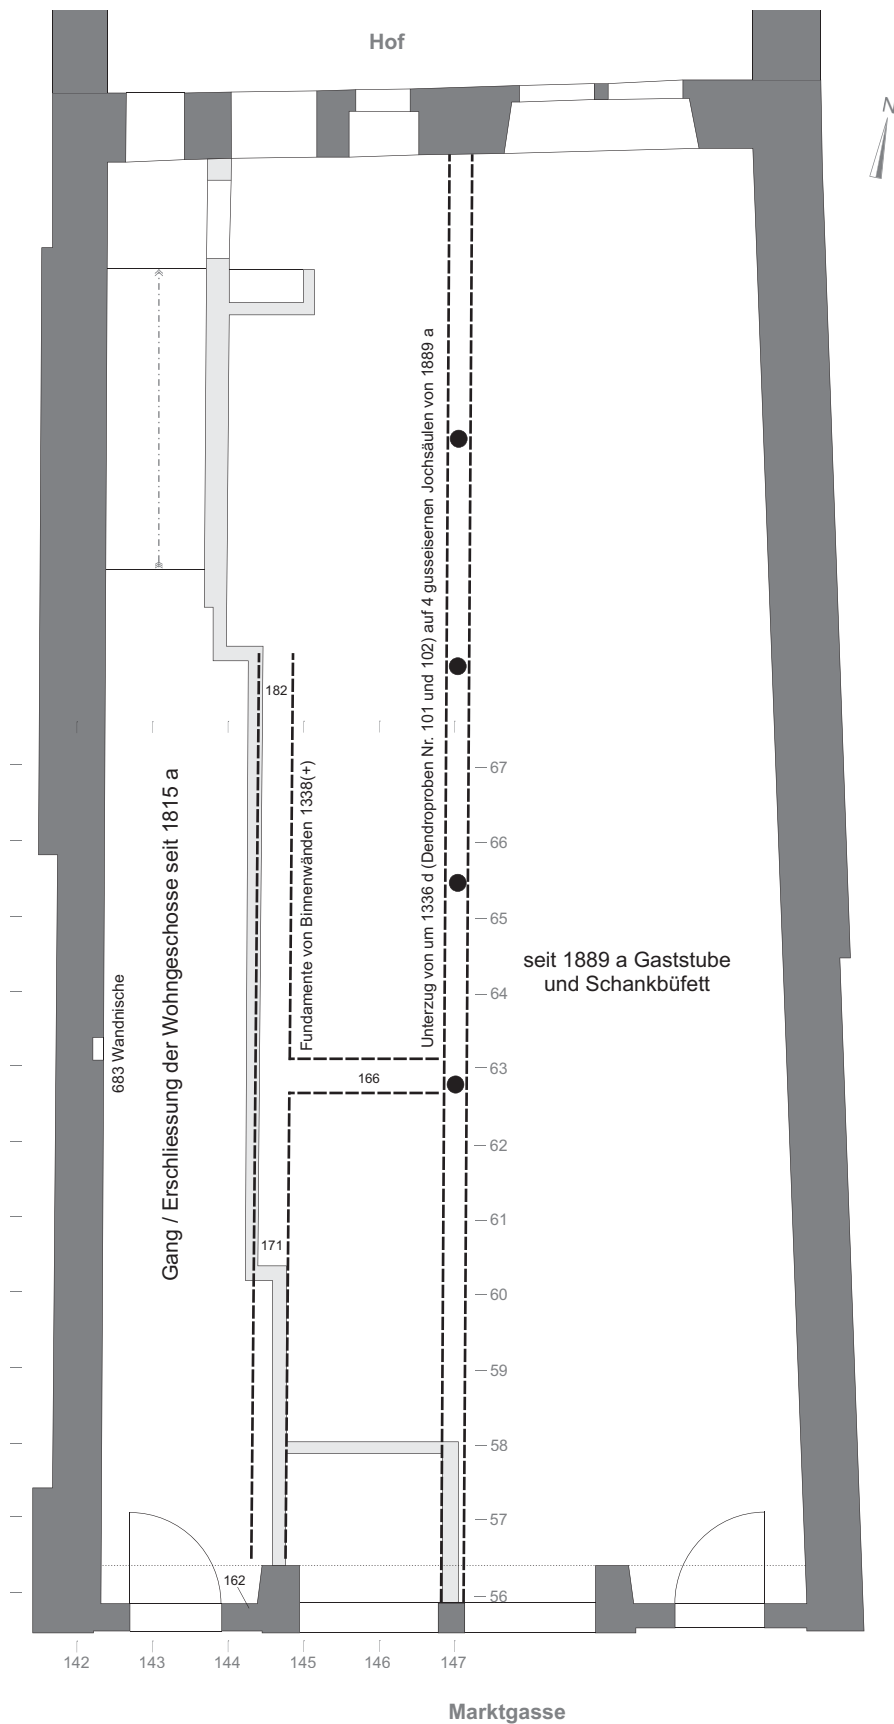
Winterthur. Marktgasse 44. Grundriss Erdgeschoss mit Graueintrag der jüngsten Binnenwände. M. 1:100.
